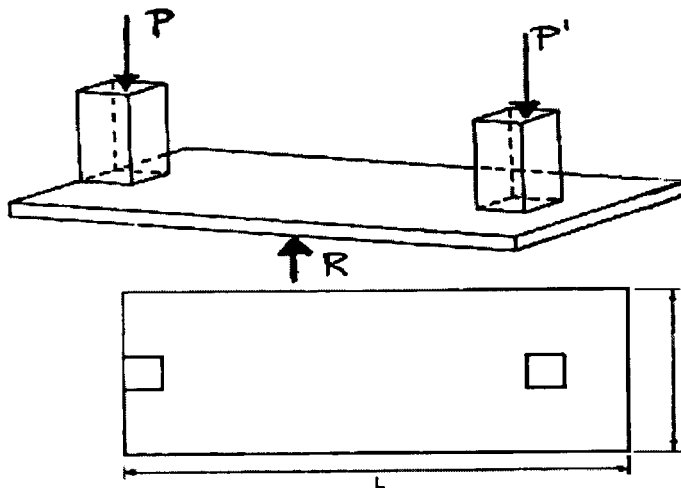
Zapata Combinada(por medio de losa de cimentación).
